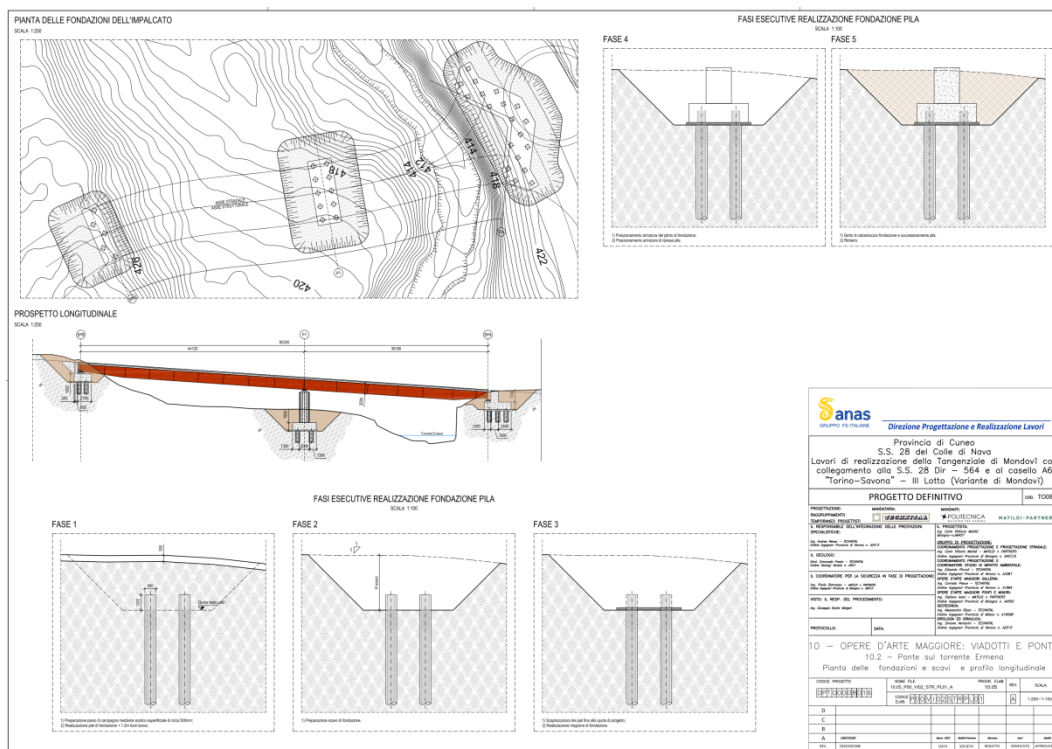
scavi per la realizzazione delle fondazioni sul torrente Ermena
